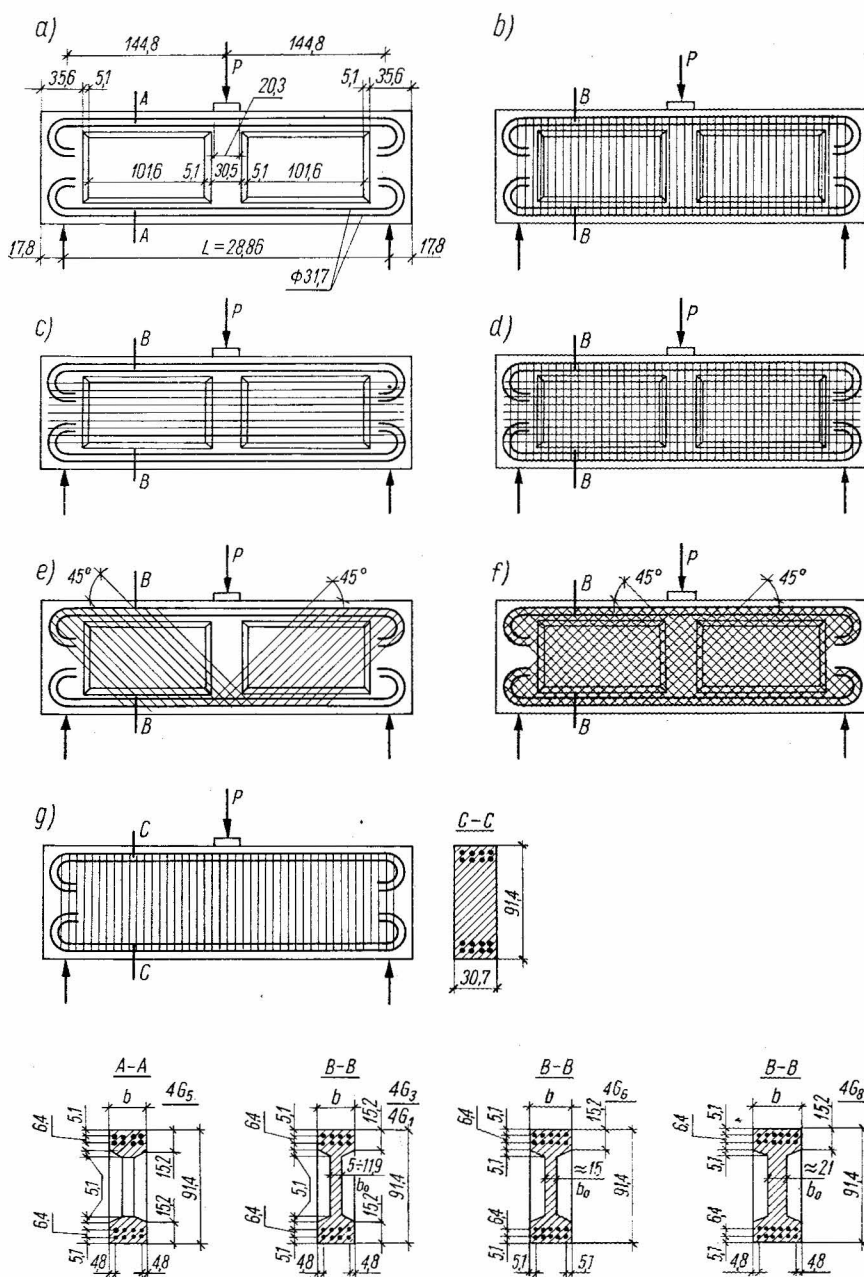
Essais américain [77] : a) poutres sans âme ou avec âme mais sans armature transversale, b) poutres avec l'armature transversale en forme d'étriers verticaux, c) id. avec des étriers horizontaux, d) poutres armées simultanément d'étriers verticaux et horizontaux, e) poutres à étriers inclinés, f) poutres à deux systèmes orthogonaux d'étriers inclinés, g) poutre rectangulaire munie d'une armature transversale en forme d'étriers verticaux
